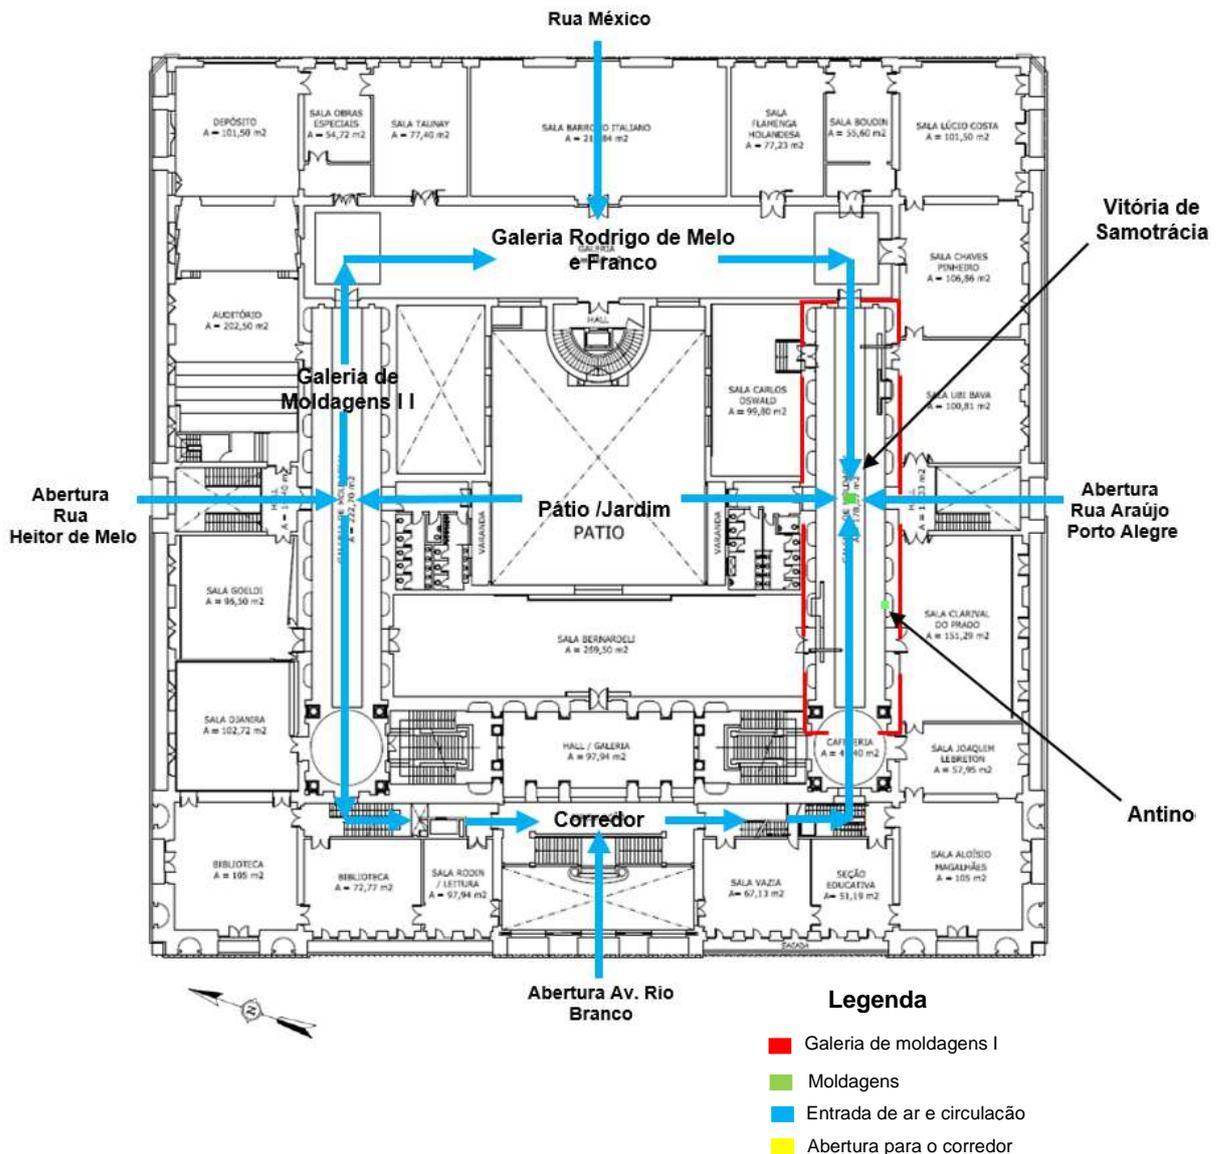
Planta baixa – 2º Pavimento com inserções para localização da Galeria de Moldagens I, obras selecionadas e a entrada e circulação de ar no MNBA.
